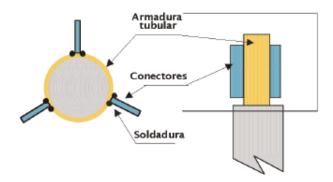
Mejora de adherencia mediante la soldadura de placas de acero (Vista en planta y perfil)
